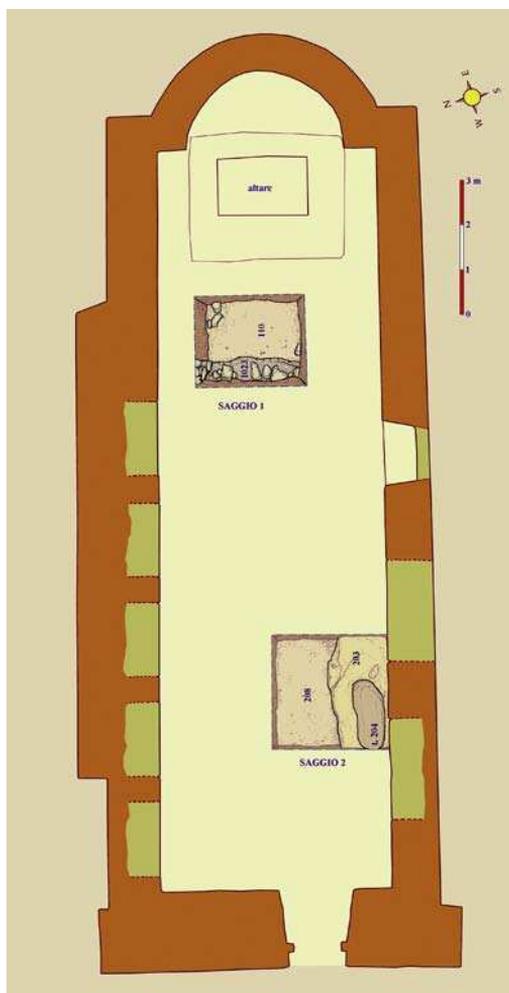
Chiesa di San Pietro: planimetria generale (E. Canzonieri).
